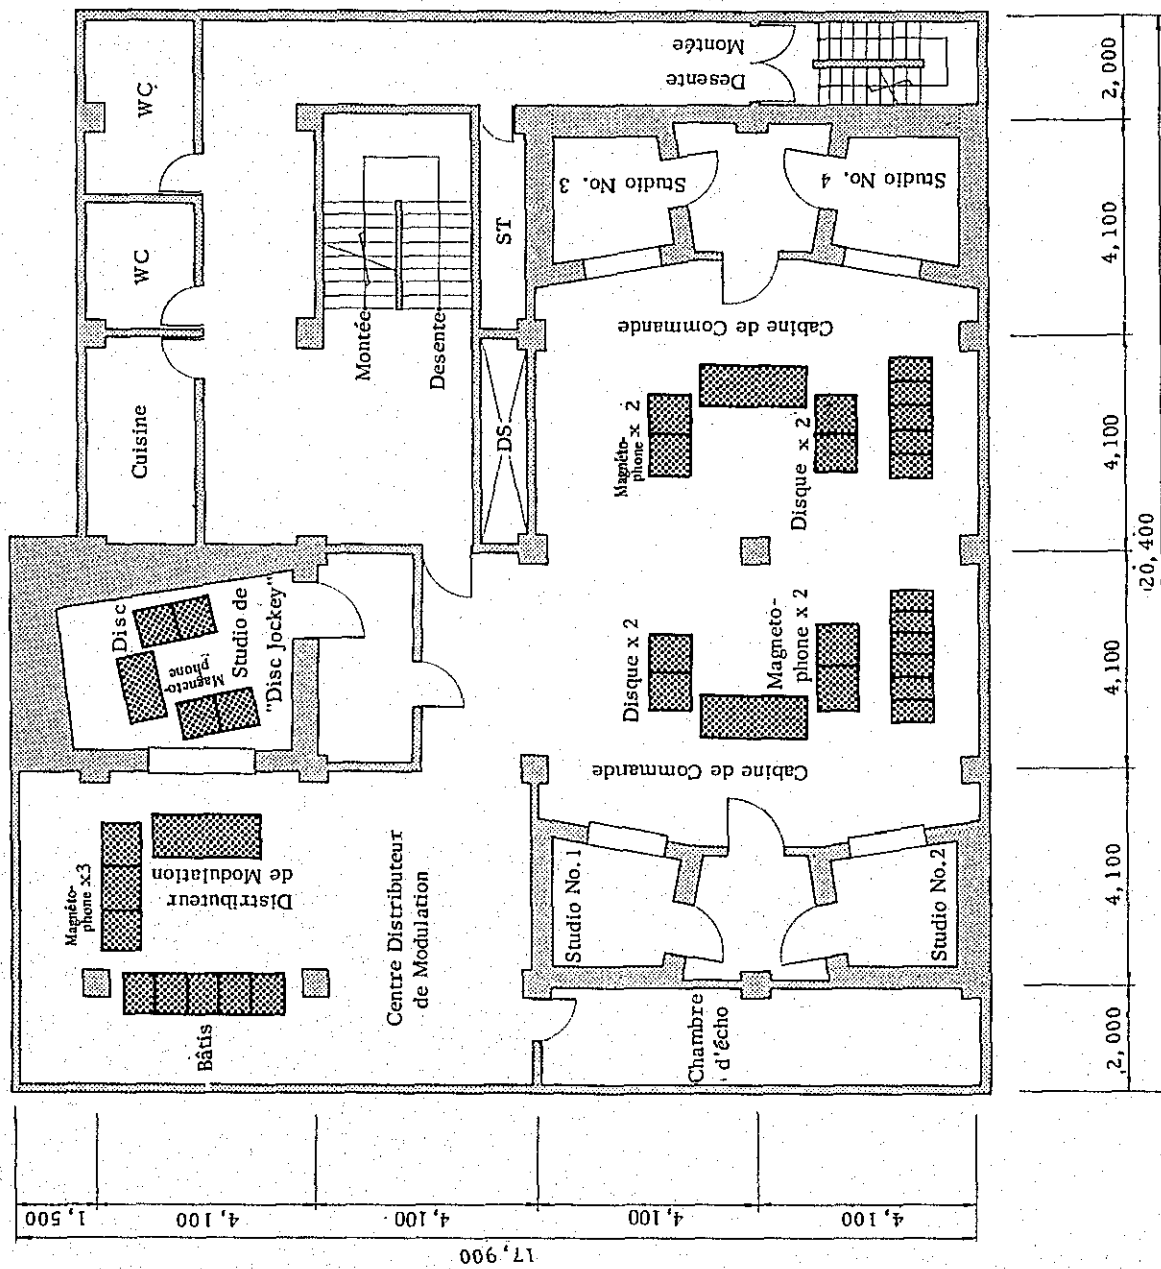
PLAN DE TRACE D'UN NOUVEAU BATIMENT DU STUDIO DE RADIO - PLAN DU 2E ETAGE
